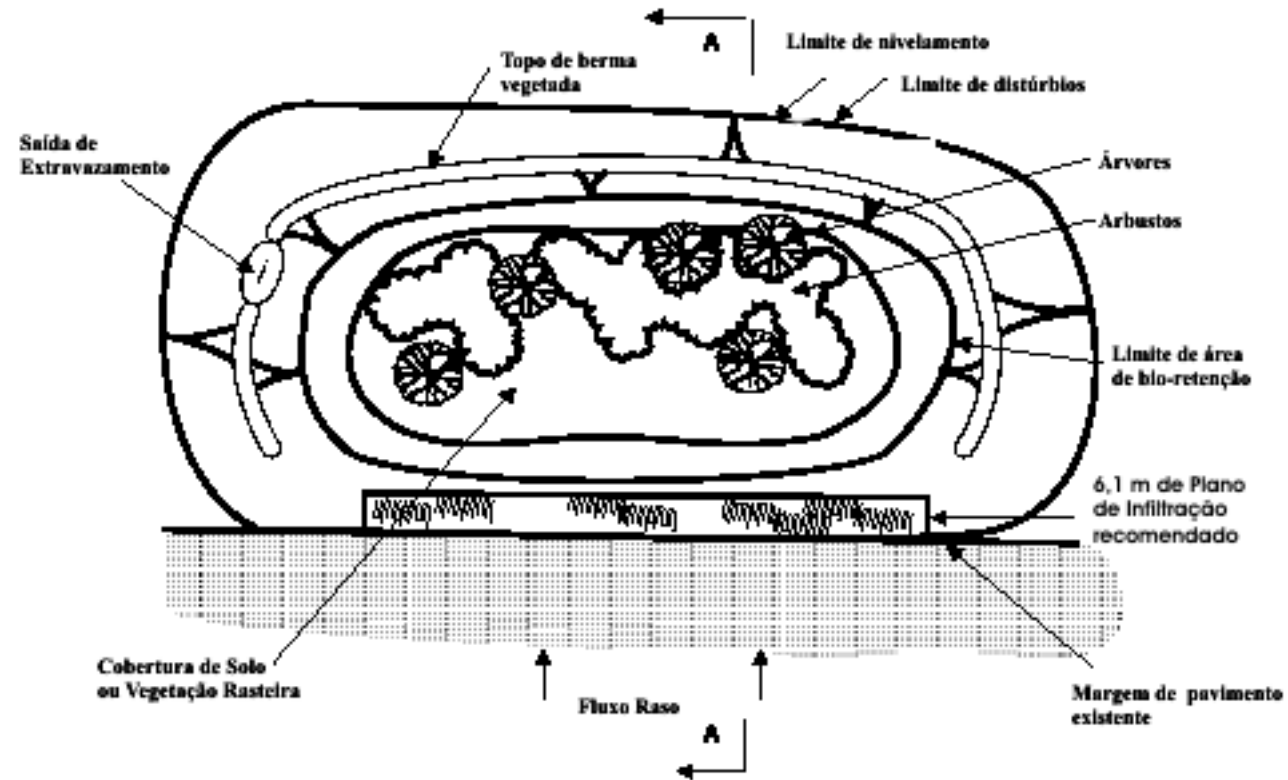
Planta baixa de uma bio-retenção (fora de escala).
